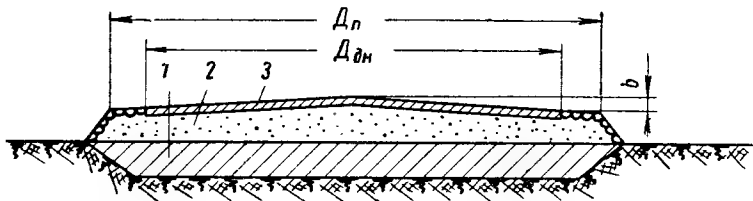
Схема устройства основания под вертикальный цилиндрический резервуар
